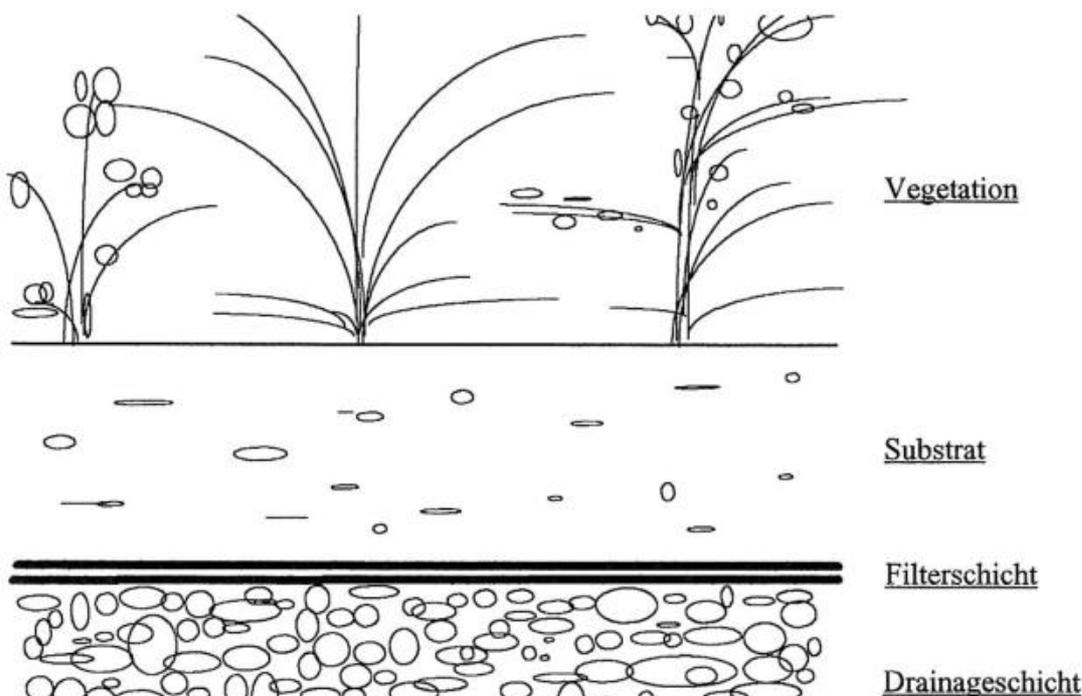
Aufbau einer Dachbegrünung (z.B. Drei-Schicht-Aufbau)
